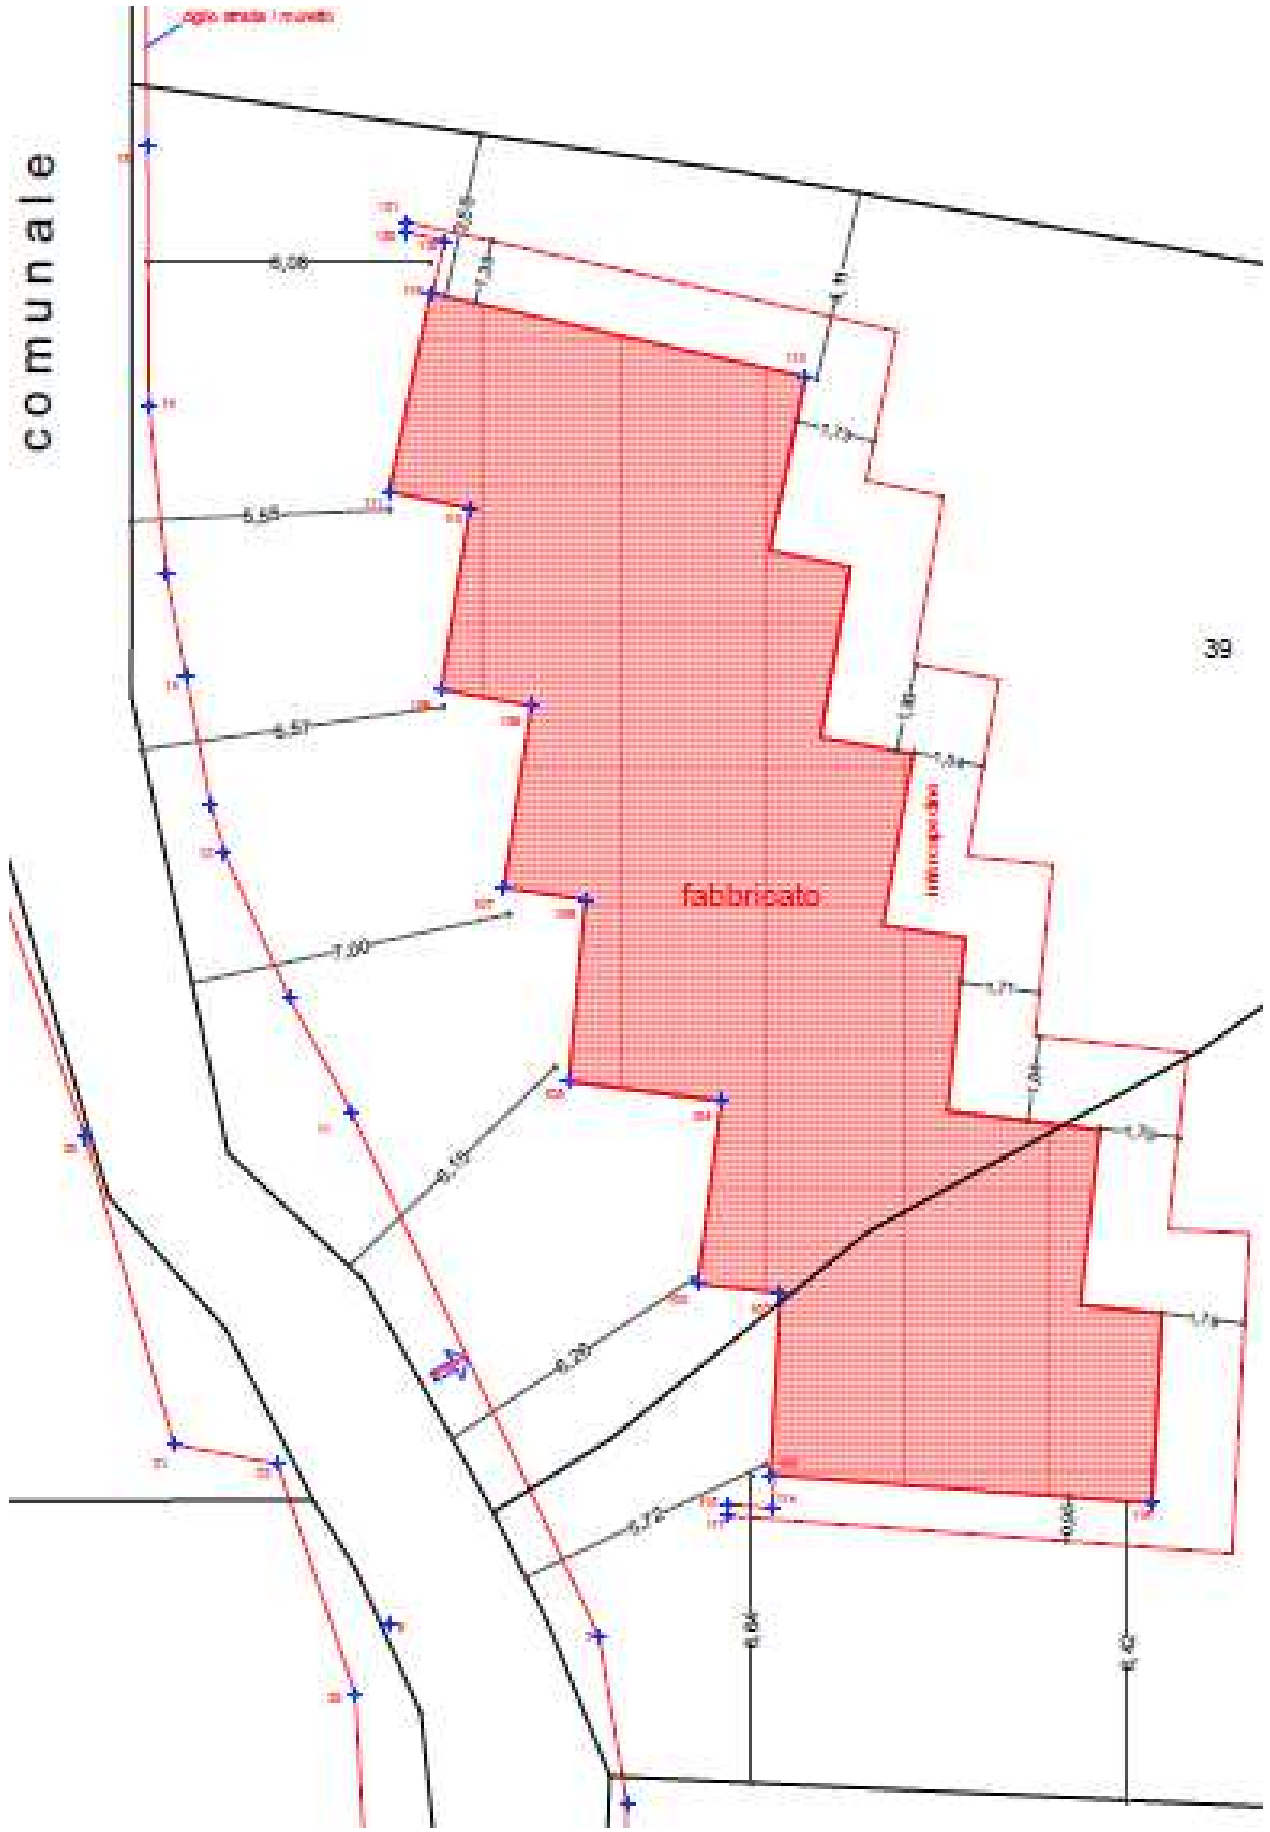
Rilievo planimetrico ed inquadramento catastale – zoom sul lotto
